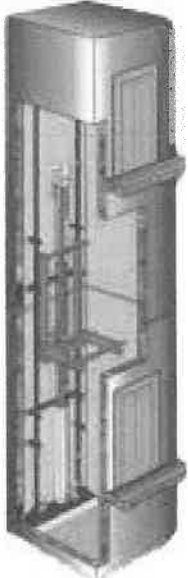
esempio tipico di vano corsa in struttura cemento armato
